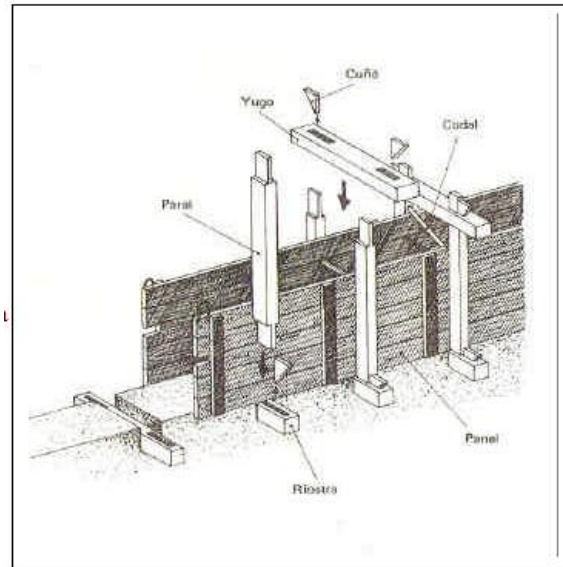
Partes del encofrado para un muro en tapia pisada. Adaptada de Camino sostenible.
